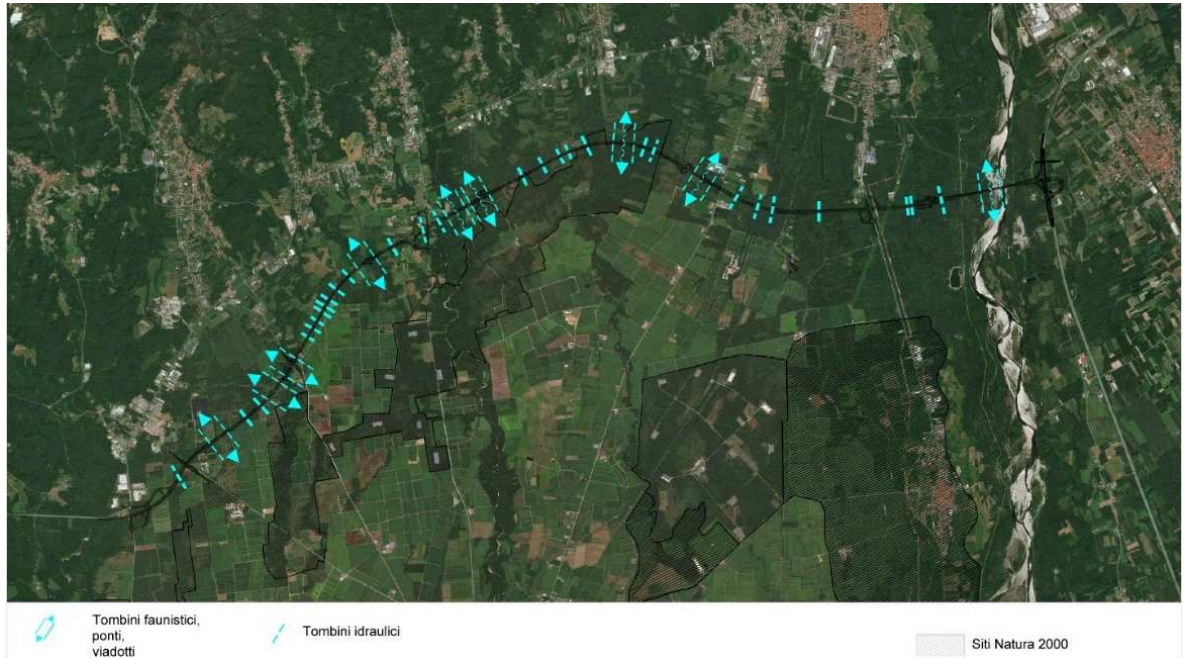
Interventi di mitigazione faunistica: attraversamenti previsti
